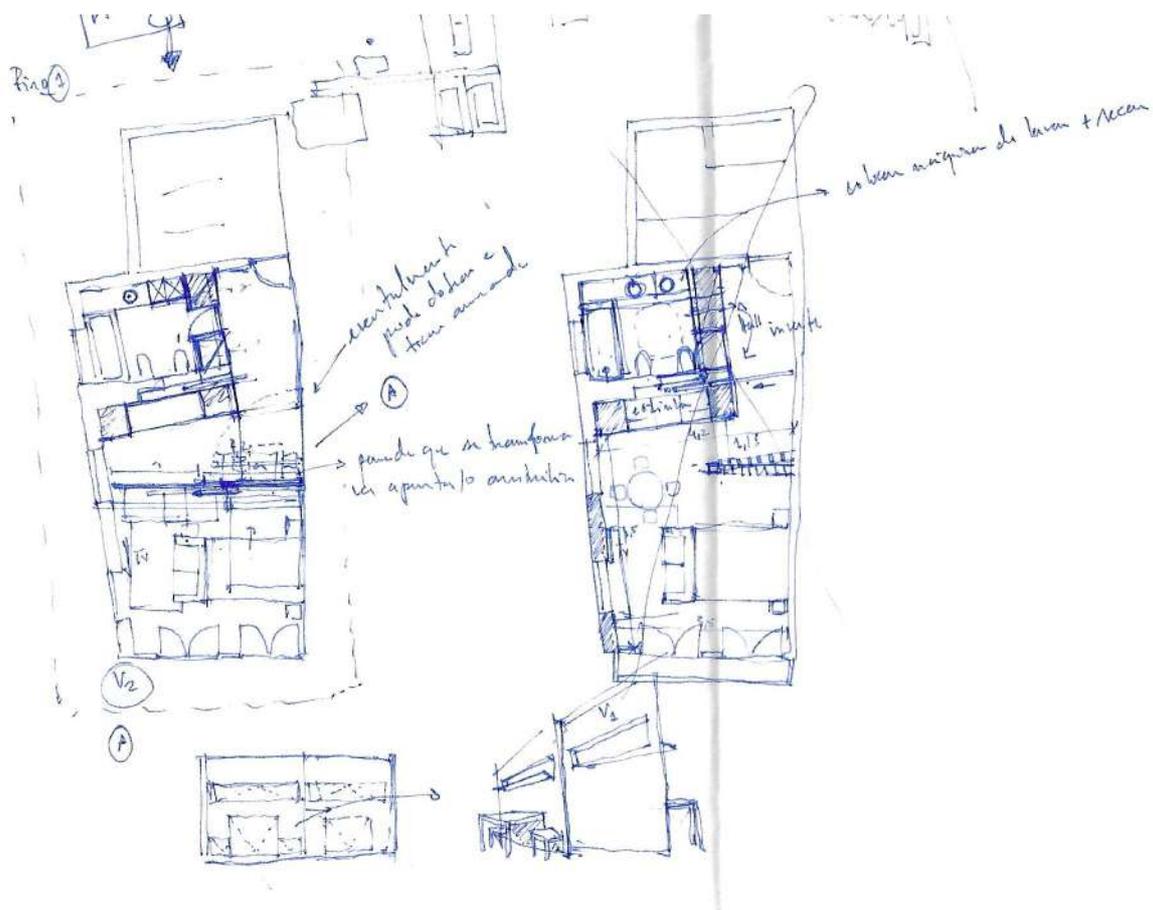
Croqui Arquiteto Filipe Vilas Boas
